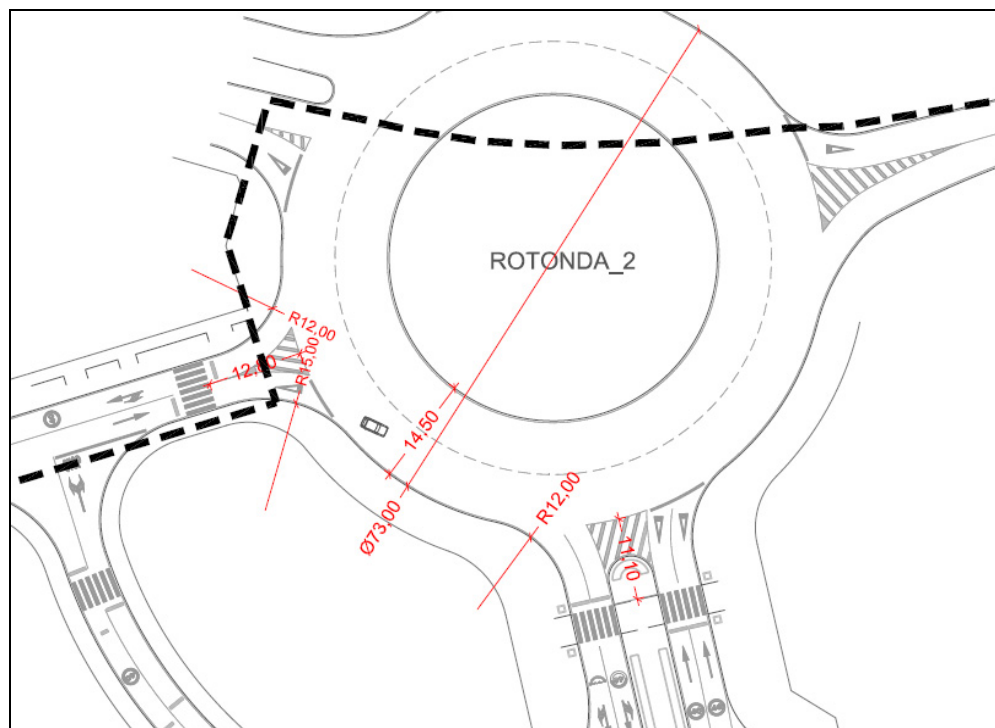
Planta de la rotonda 2 (Norte) de la vía estructurante de Tamaraceite
